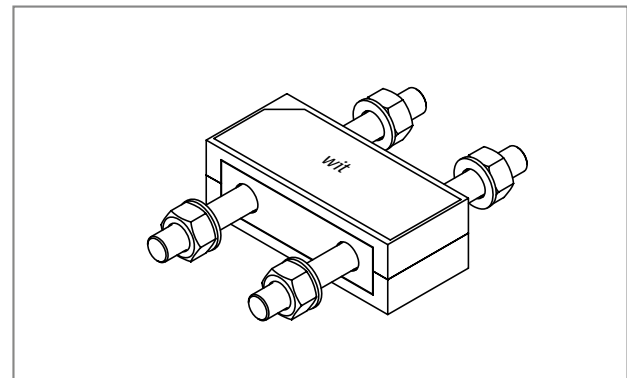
Schöck Isokorb® T type S-N-D16: Vooraanzicht
